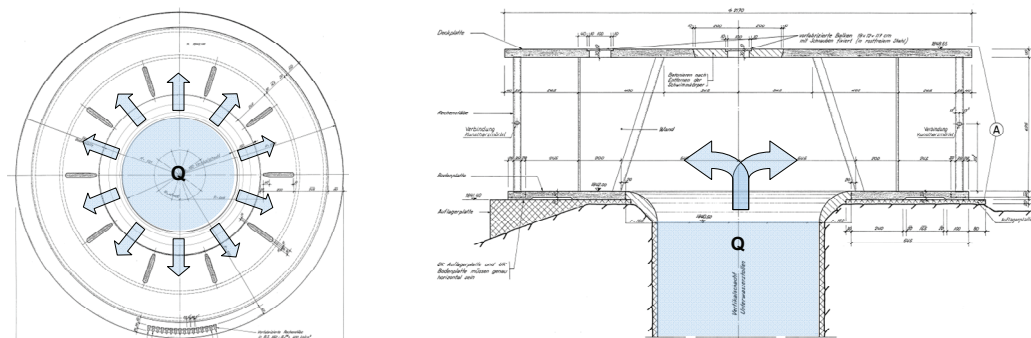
Grundriss und Aufriss des Ein-/Auslaufbauwerkes im Grimselsee
